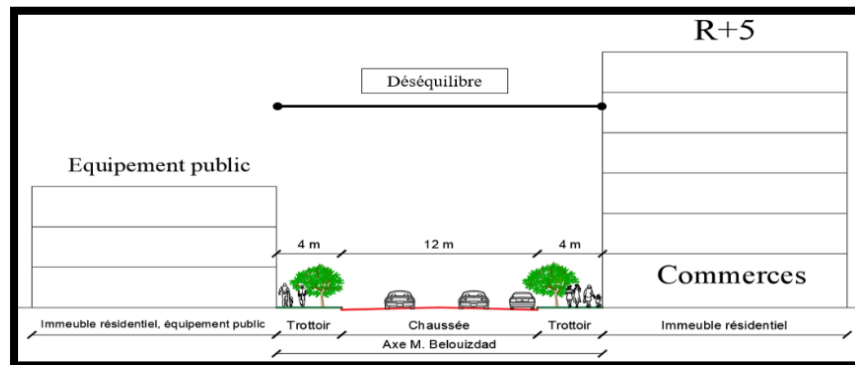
Coupe schématique rue Mohammed Belouizdad.
